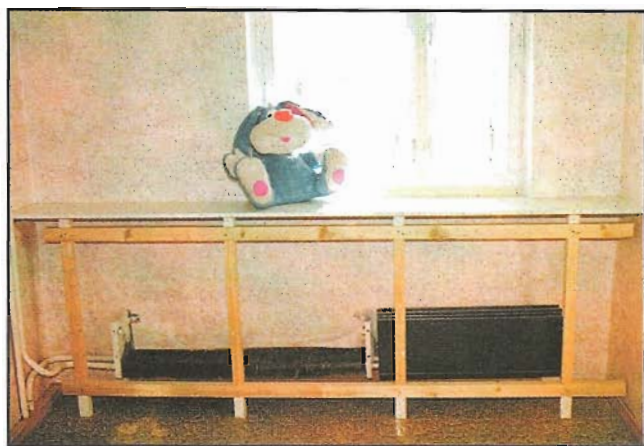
Предварительно на высоте установки подоконника продолбили паз в стене от откосов до смежных стен ниши.
